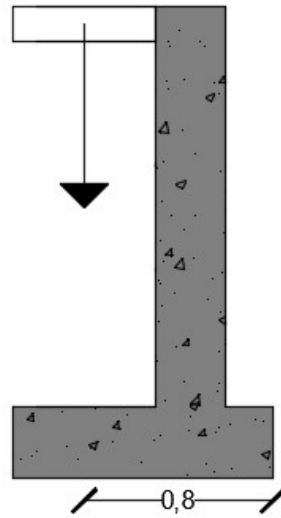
Diagrama de fuerzas – Peso del pavimento rígido
